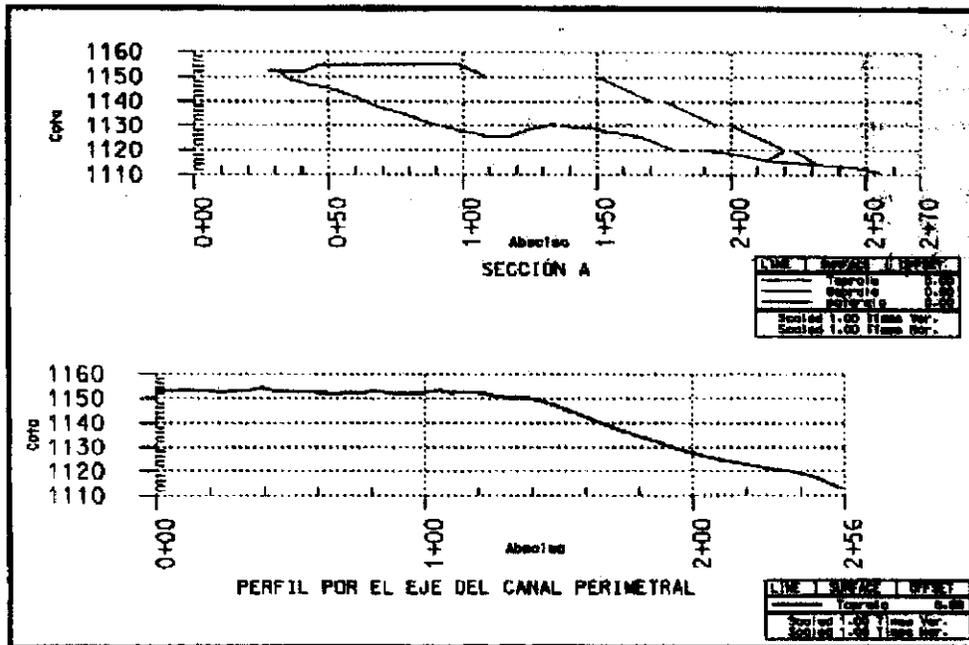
Sección Depósito y perfil Canal Perimetral
